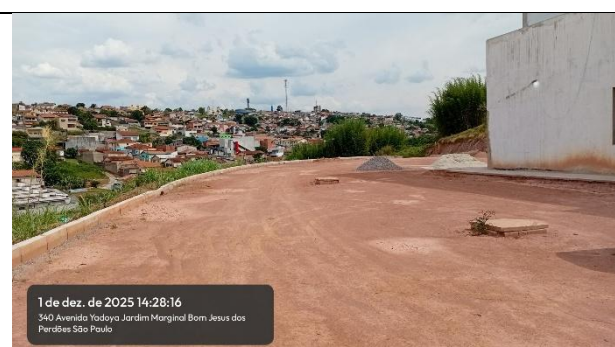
Situação externa da obra (infraestrutura inacabada)
